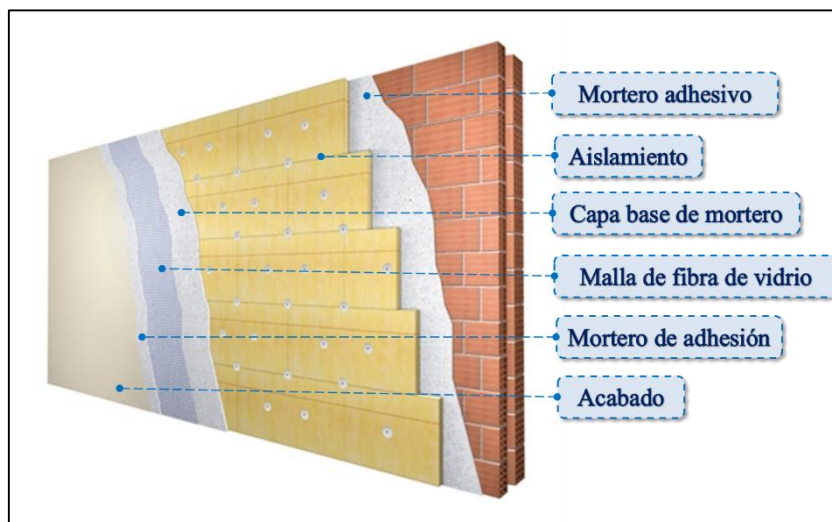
Detalle constructivo sistema SATE. Fuente: Elaboración propia a partir de Google Imágenes.
